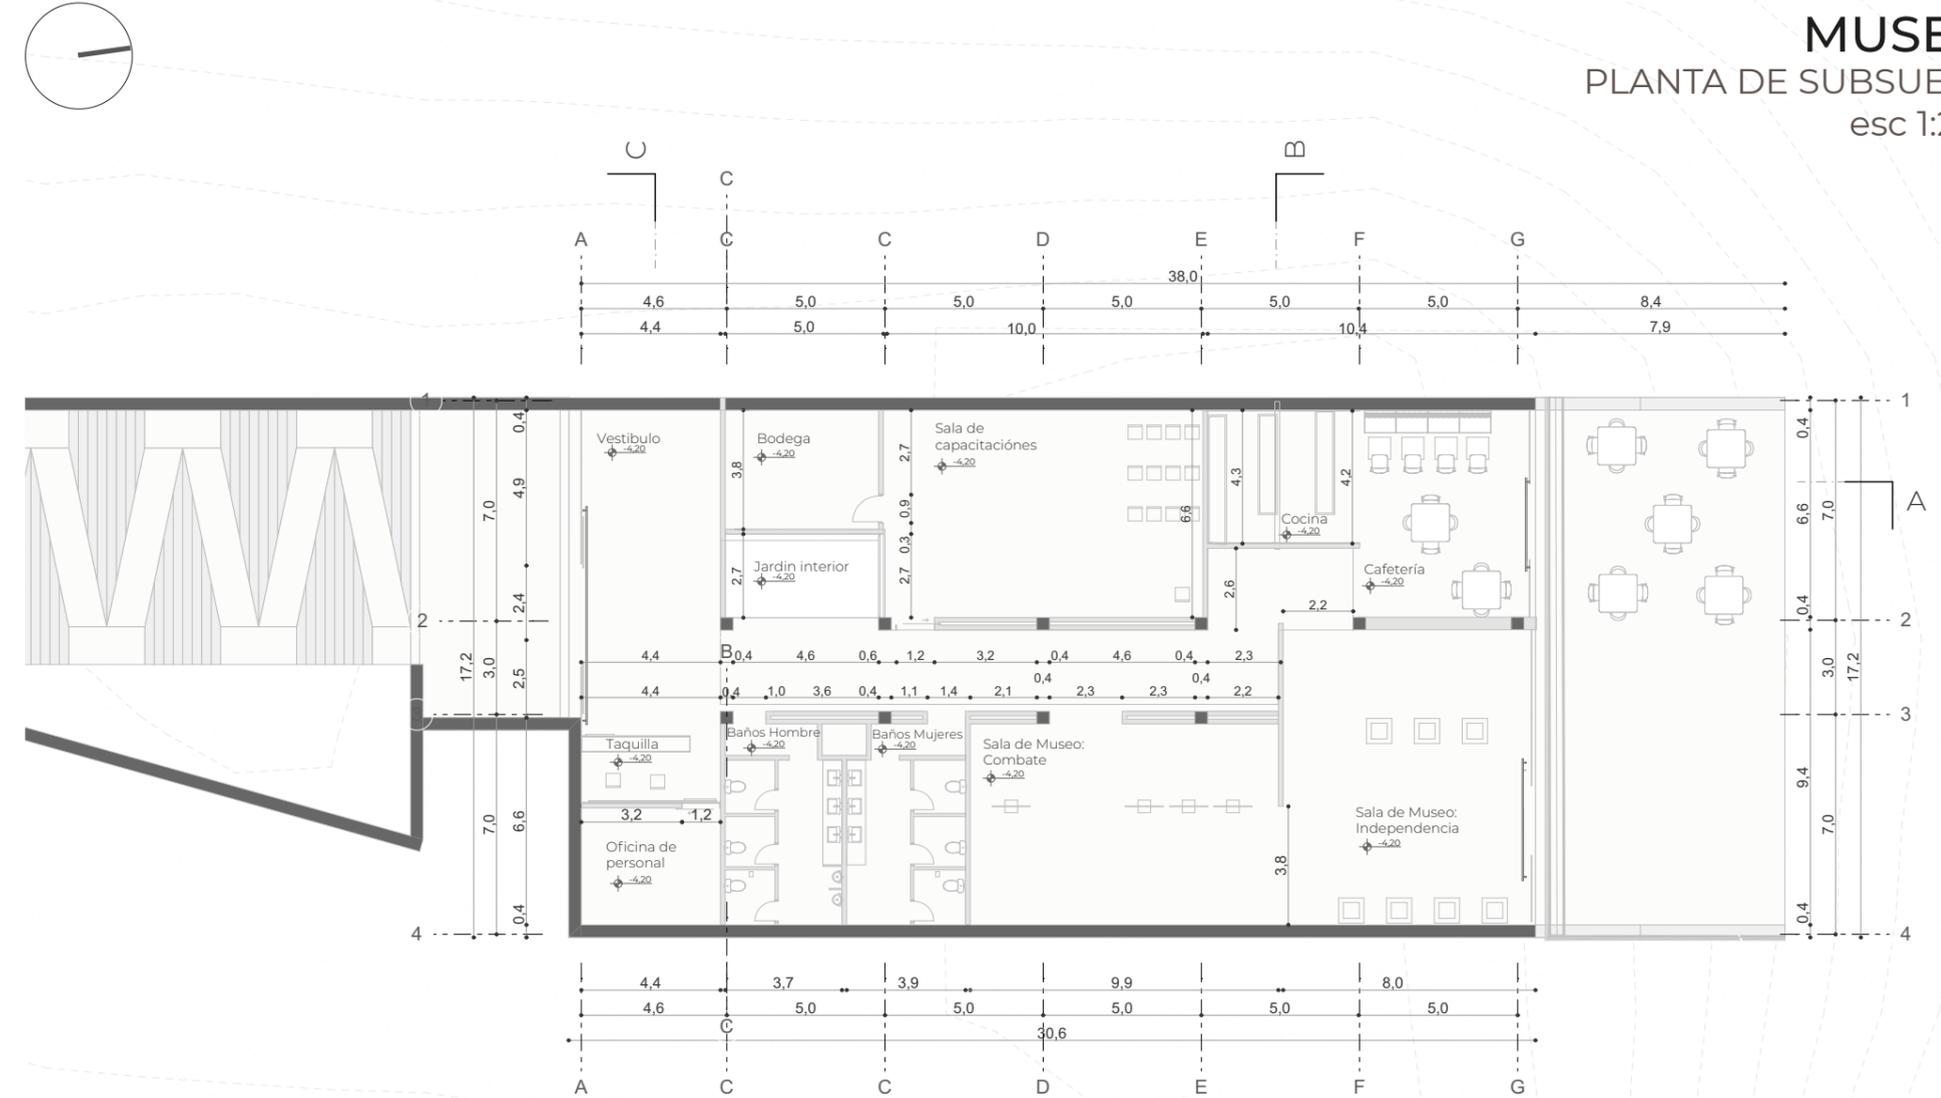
Planta arquitectónica del museo. Fuente: autores de la tesis (2020).
